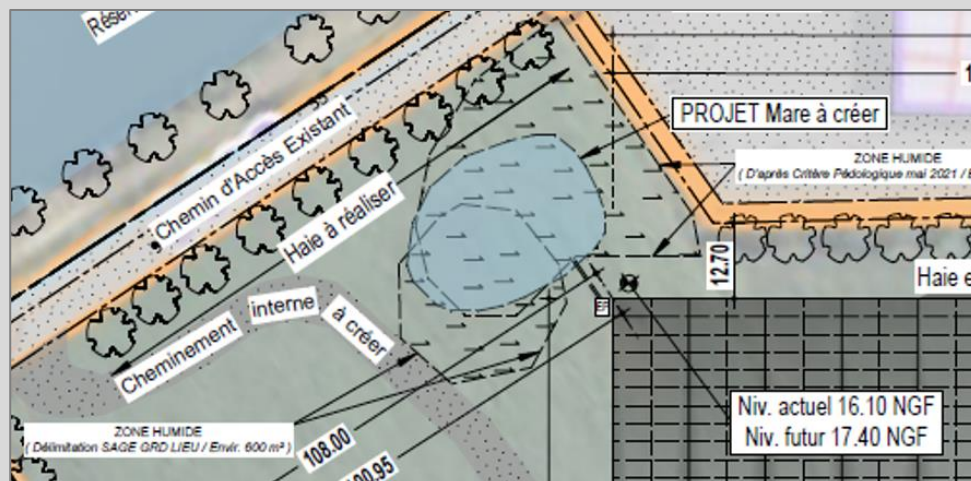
Extrait du plan masse d'intention (Source : SICA, sept.2021)
